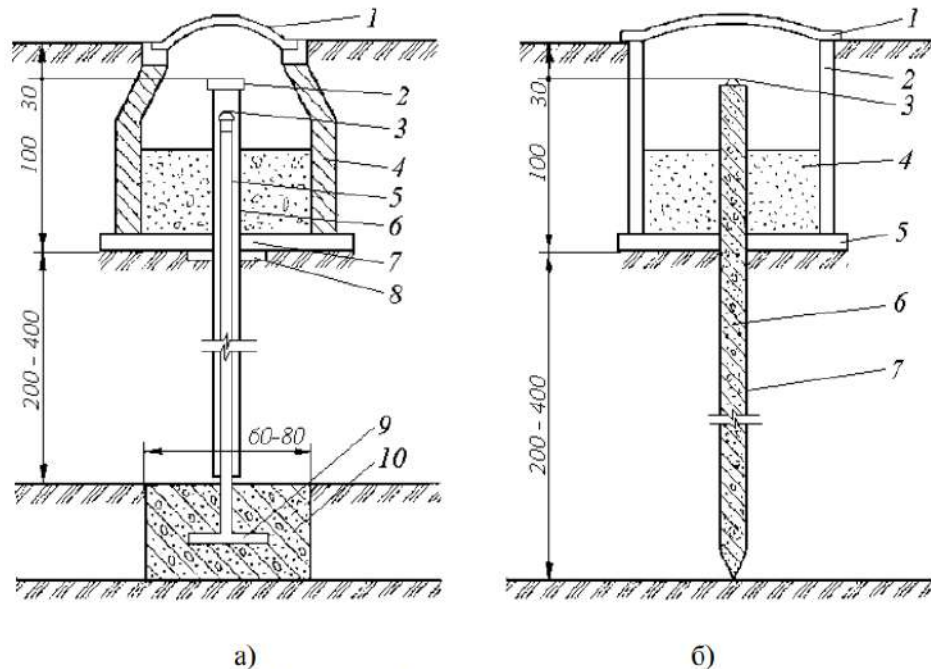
Ґрунтовий репер: а) трубчастий на бетонному фундаменті: 1 – люк; 2 – кришка; 3 – реперна головка ($\varnothing$ 2–4 см); 4 – цегляний або бетонний збірний колодязь; 5 – реперна труба ($\varnothing$ 7–8 см); 6 – захисна труба ($\varnothing$ 12–15 см); 7 – бетонна підготовка; 8 – хомут для утримання захисної труби; 9 – анкерний лист; 10 – бетонна подушка; 11 – шлак; б) пальовий: 1 – люк; 2 – цегляний або бетонний збірний колодязь; 3 – реперна головка ($\varnothing$ 2–4 см); 4 – шлак; 5 – бетонна підготовка при встановленні в котлован; 6 – паля; 7 – бітум
